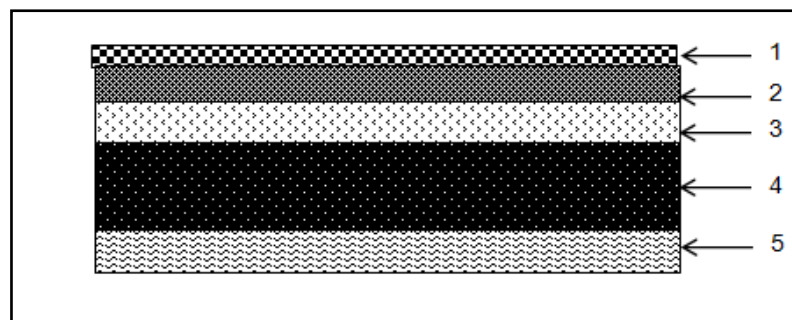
Coupe d'un plancher en dalle pleine.
